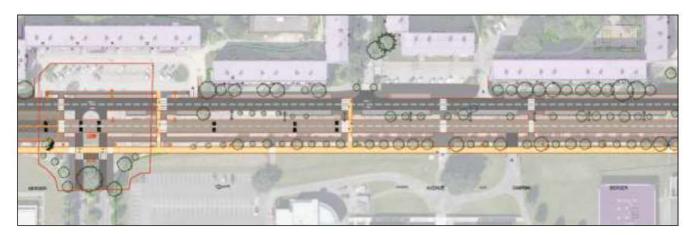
T1 Section 4.1 Avenue Gaston Berger – Proposition retenue
